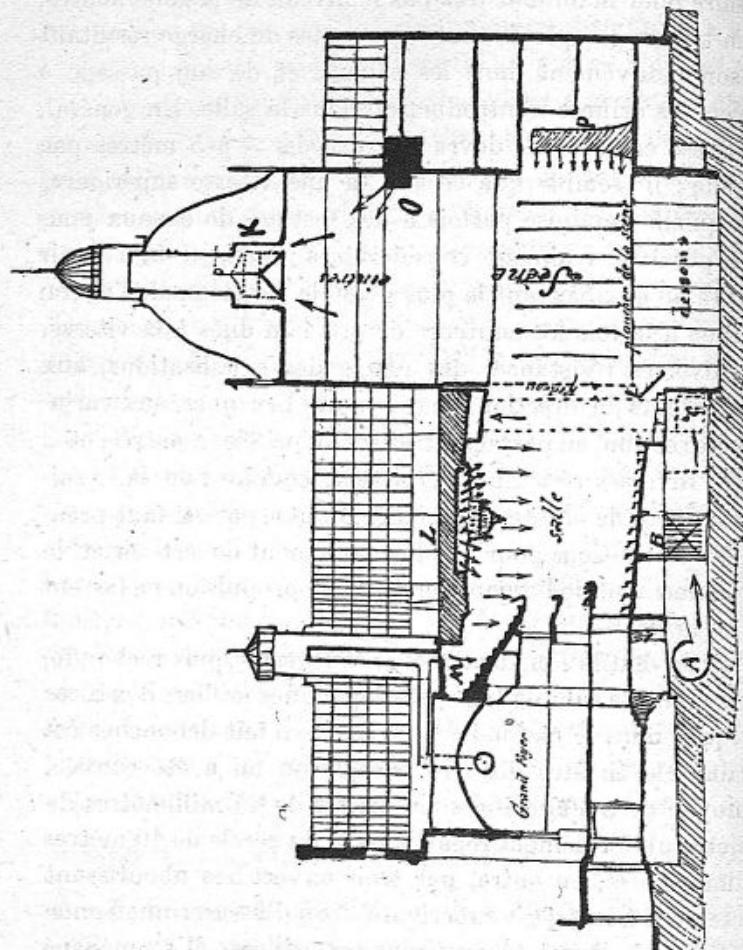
Coupe verticale longitudinale, très simplifiée, d'un théâtre rationnellement chauffé et ventilé.
